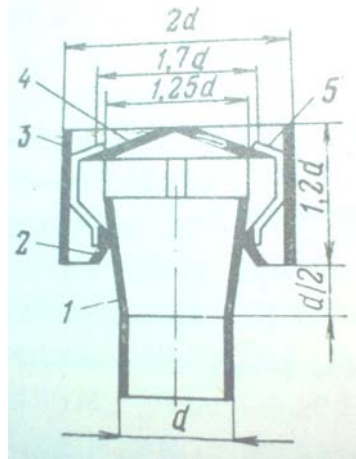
Схема дефлектора конструкції ЦАГІ:
